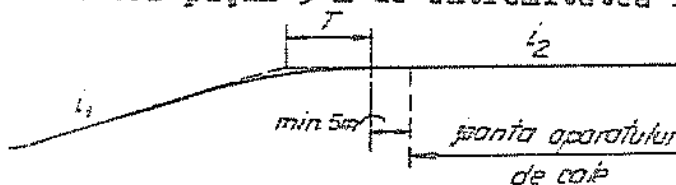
Poziția joantei aparatului de cale față de racordarea din plan vertical
